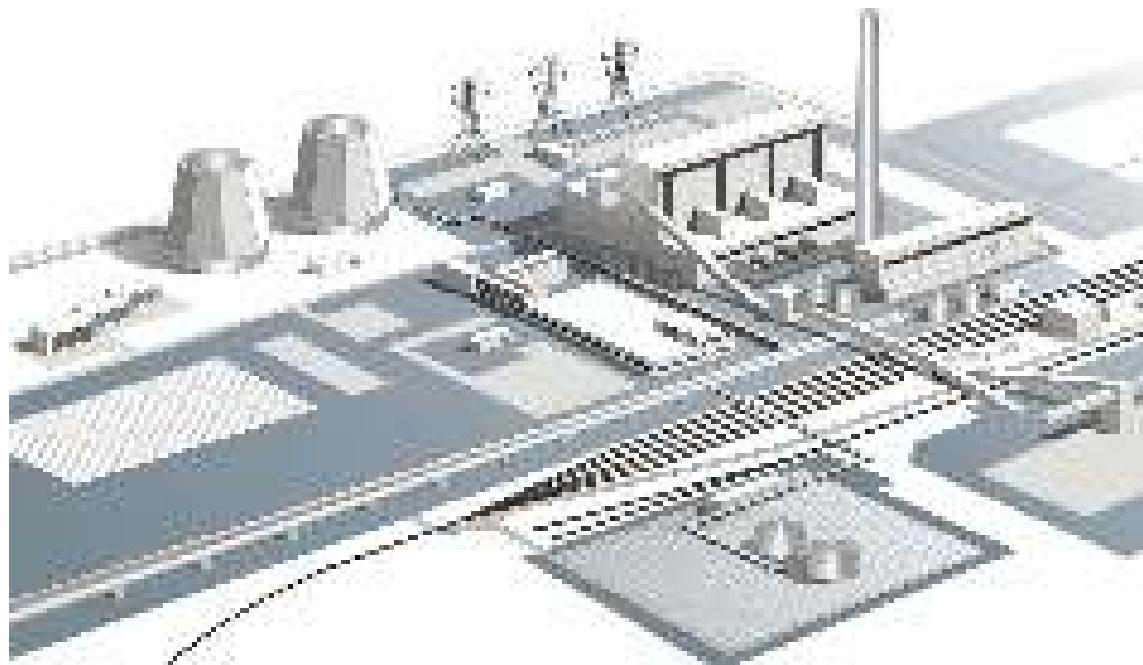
Общий вид площадки ТЭЦ на твёрдом топливе
